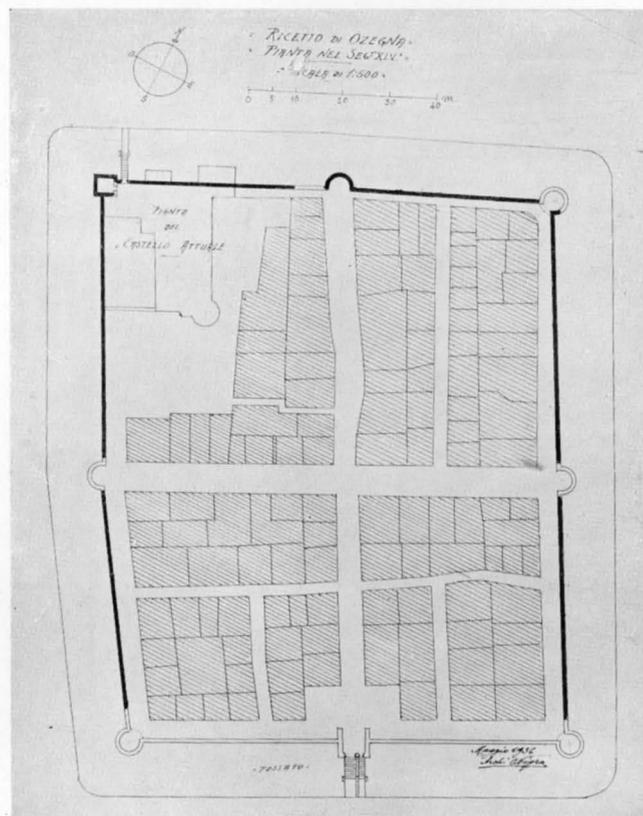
Ricetto di Ozegna - Pianta del sec. XV.
